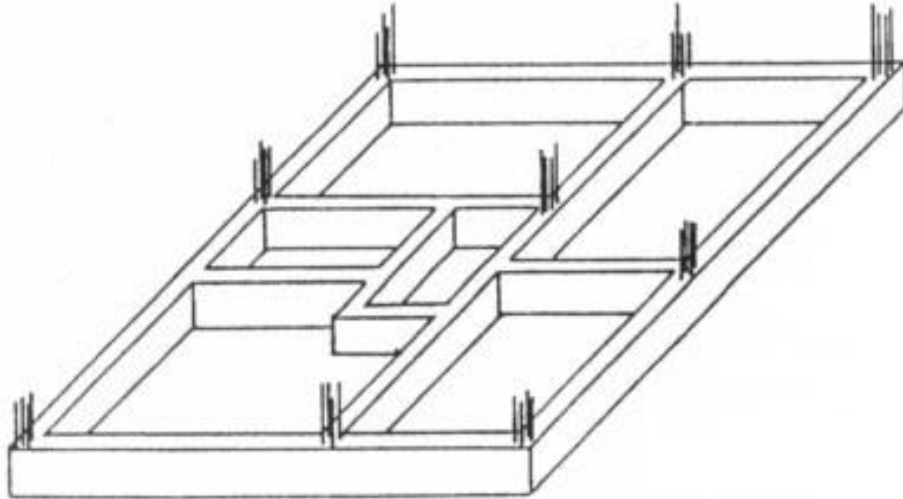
Viga Baldrame – Fonte: <http://www.fazerfacil.com.br/Construção/alicerces.htm>: Acesso em out. 2016.
